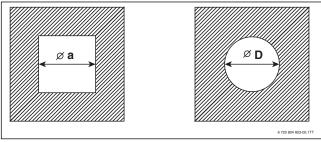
Raffigurazione cavedi: uno a sezione rettangolare, l'altro a sezione tonda
